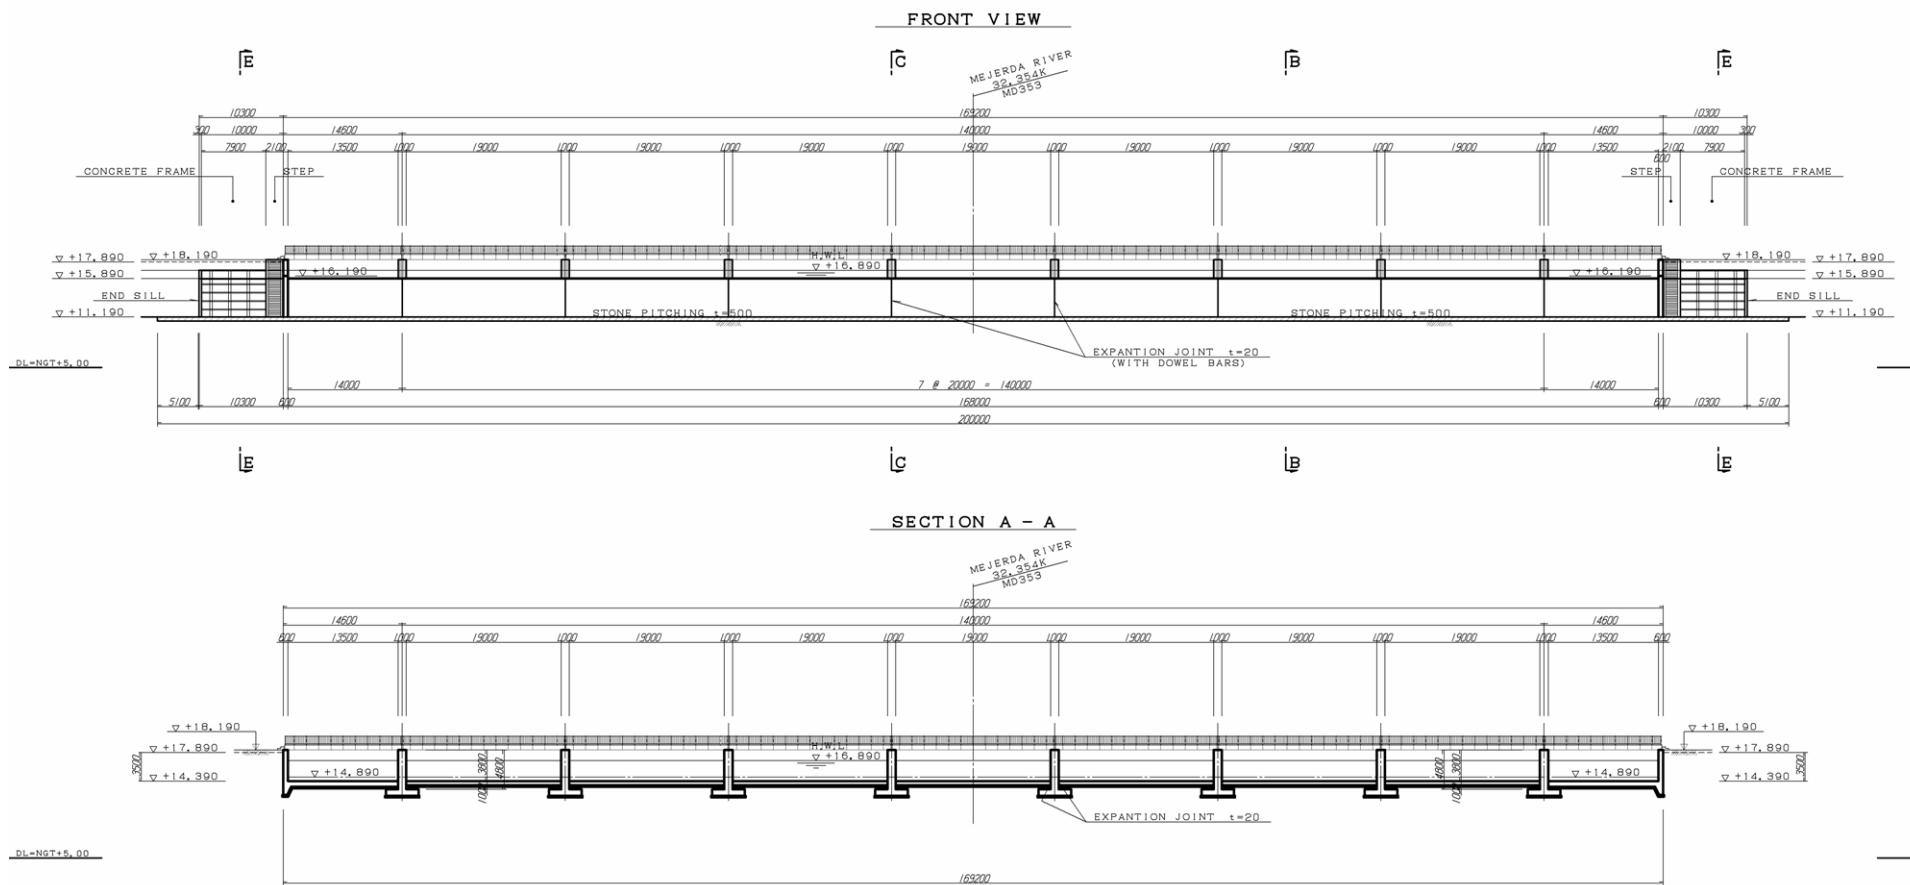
遊水地への分流堰正面図及び A-A 断面図
